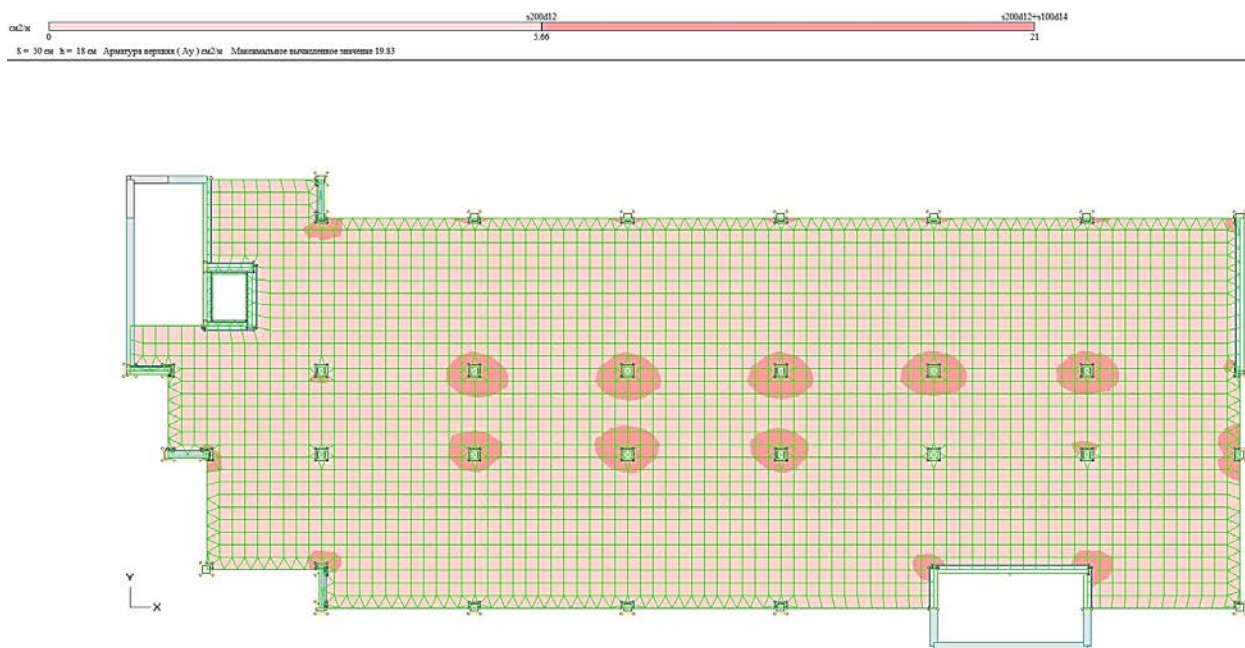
Расчетное верхнее армирование по оси Y
